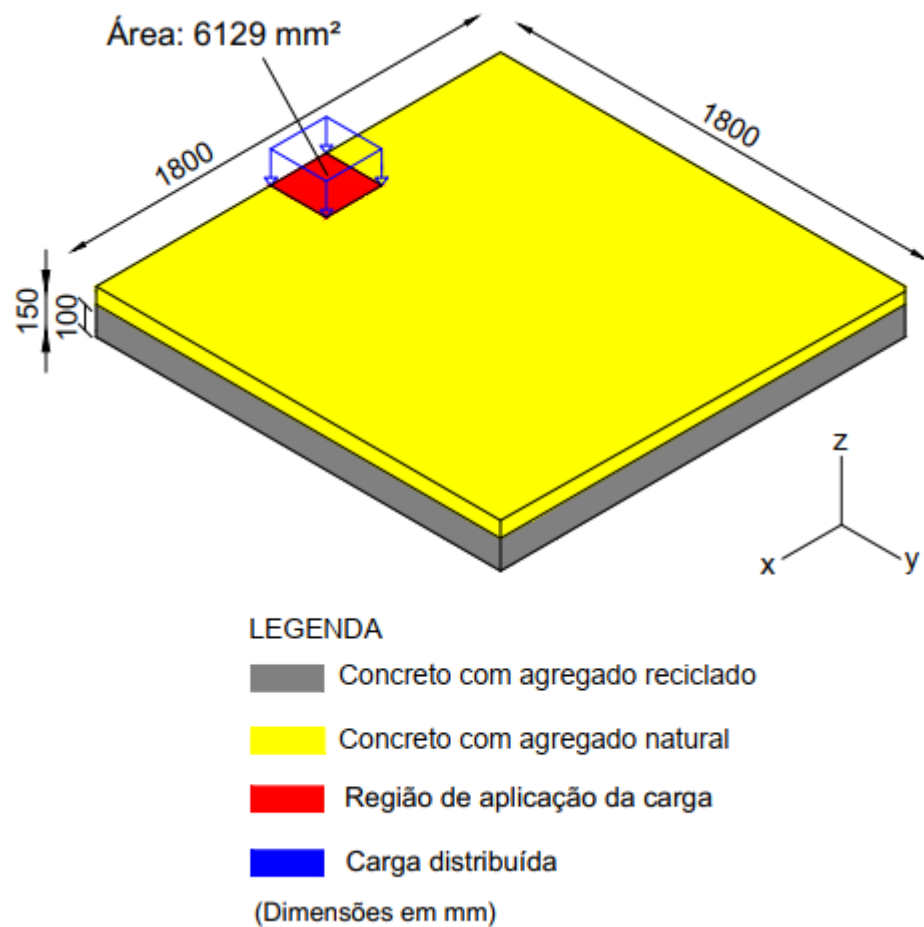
Dimensões da laje com duas camadas de concreto diferentes modelada numericamente.
